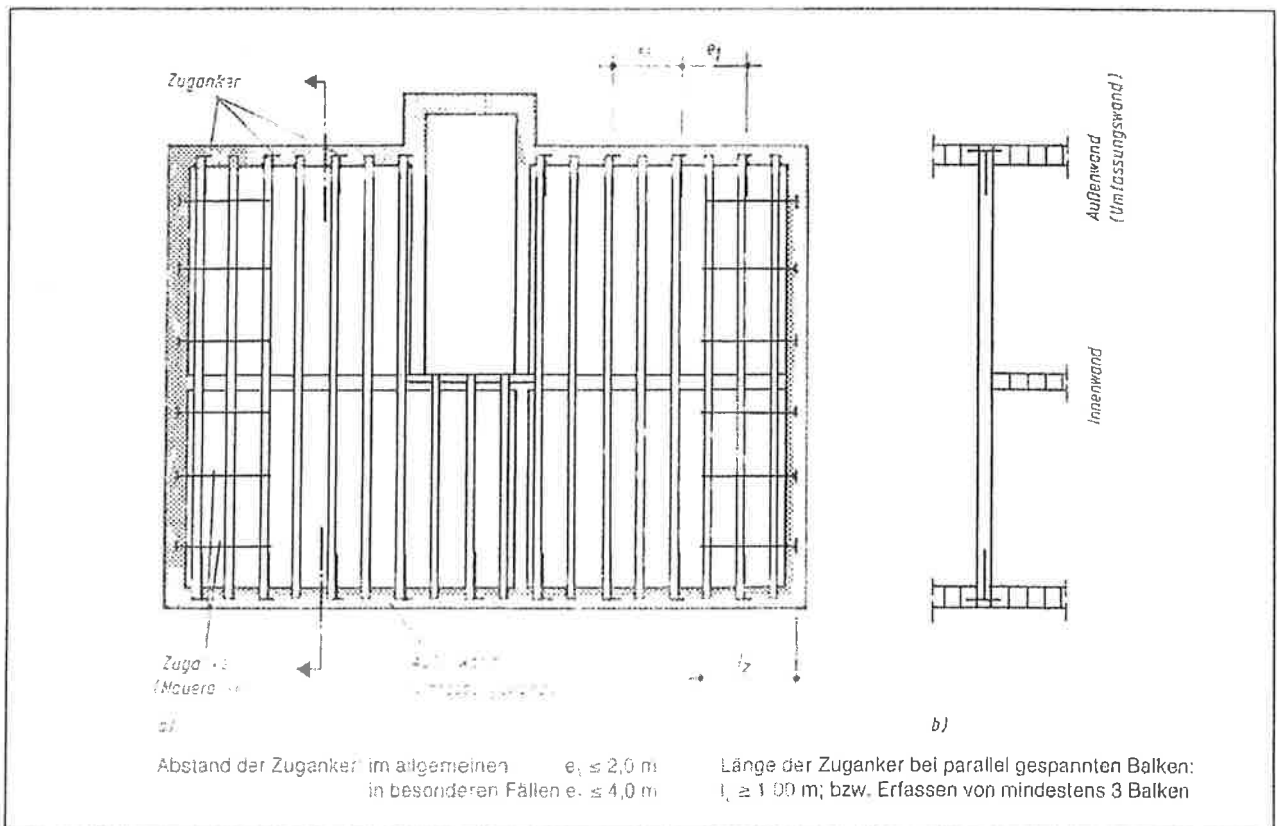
/5: Anschluß von Außenwänden (Umfassungswänden) an Holzbalkendecken a) Grundriß b) Schnitt
